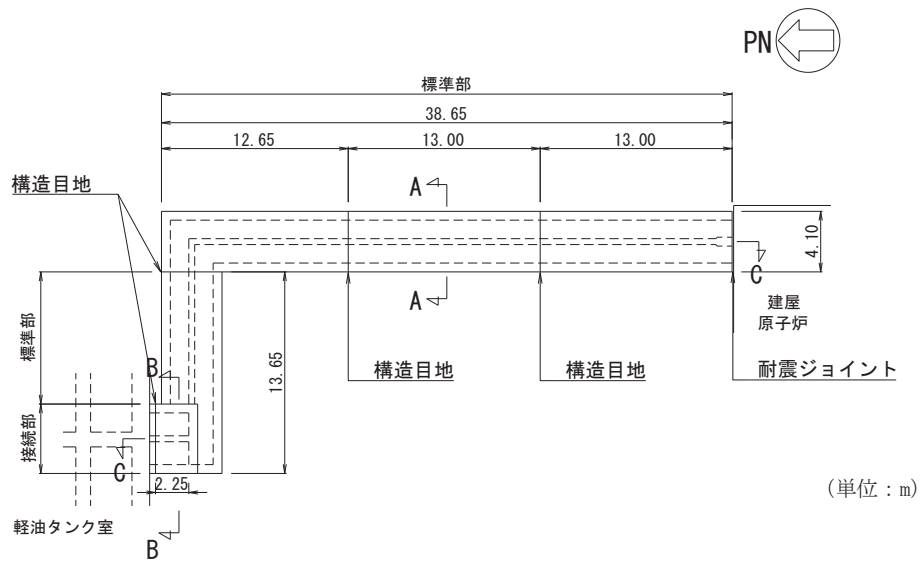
(2) 軽油タンク連絡ダクト平面図 (詳細)
